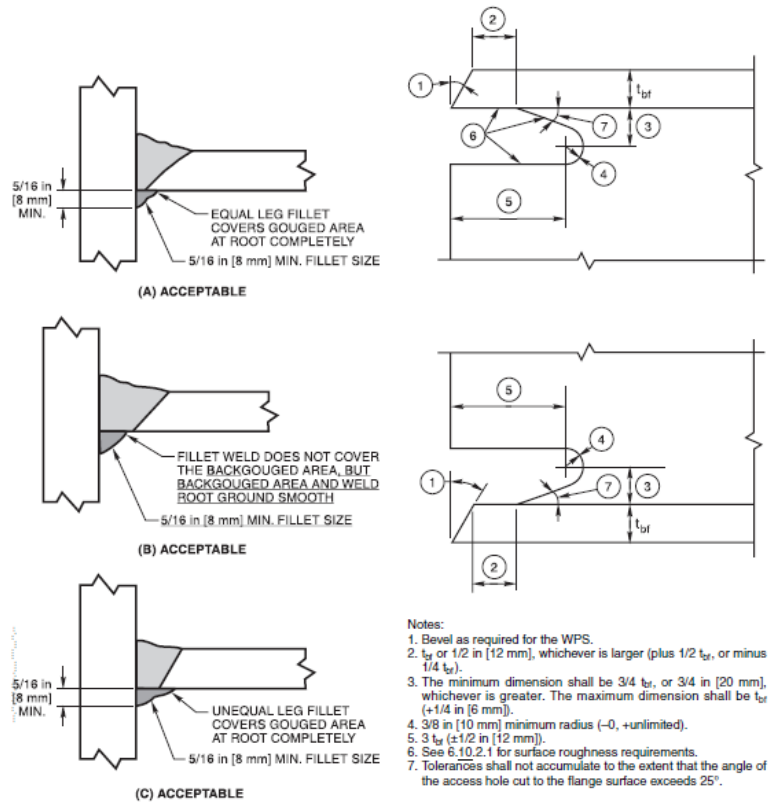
Geometría del orificio de acceso de soldadura
